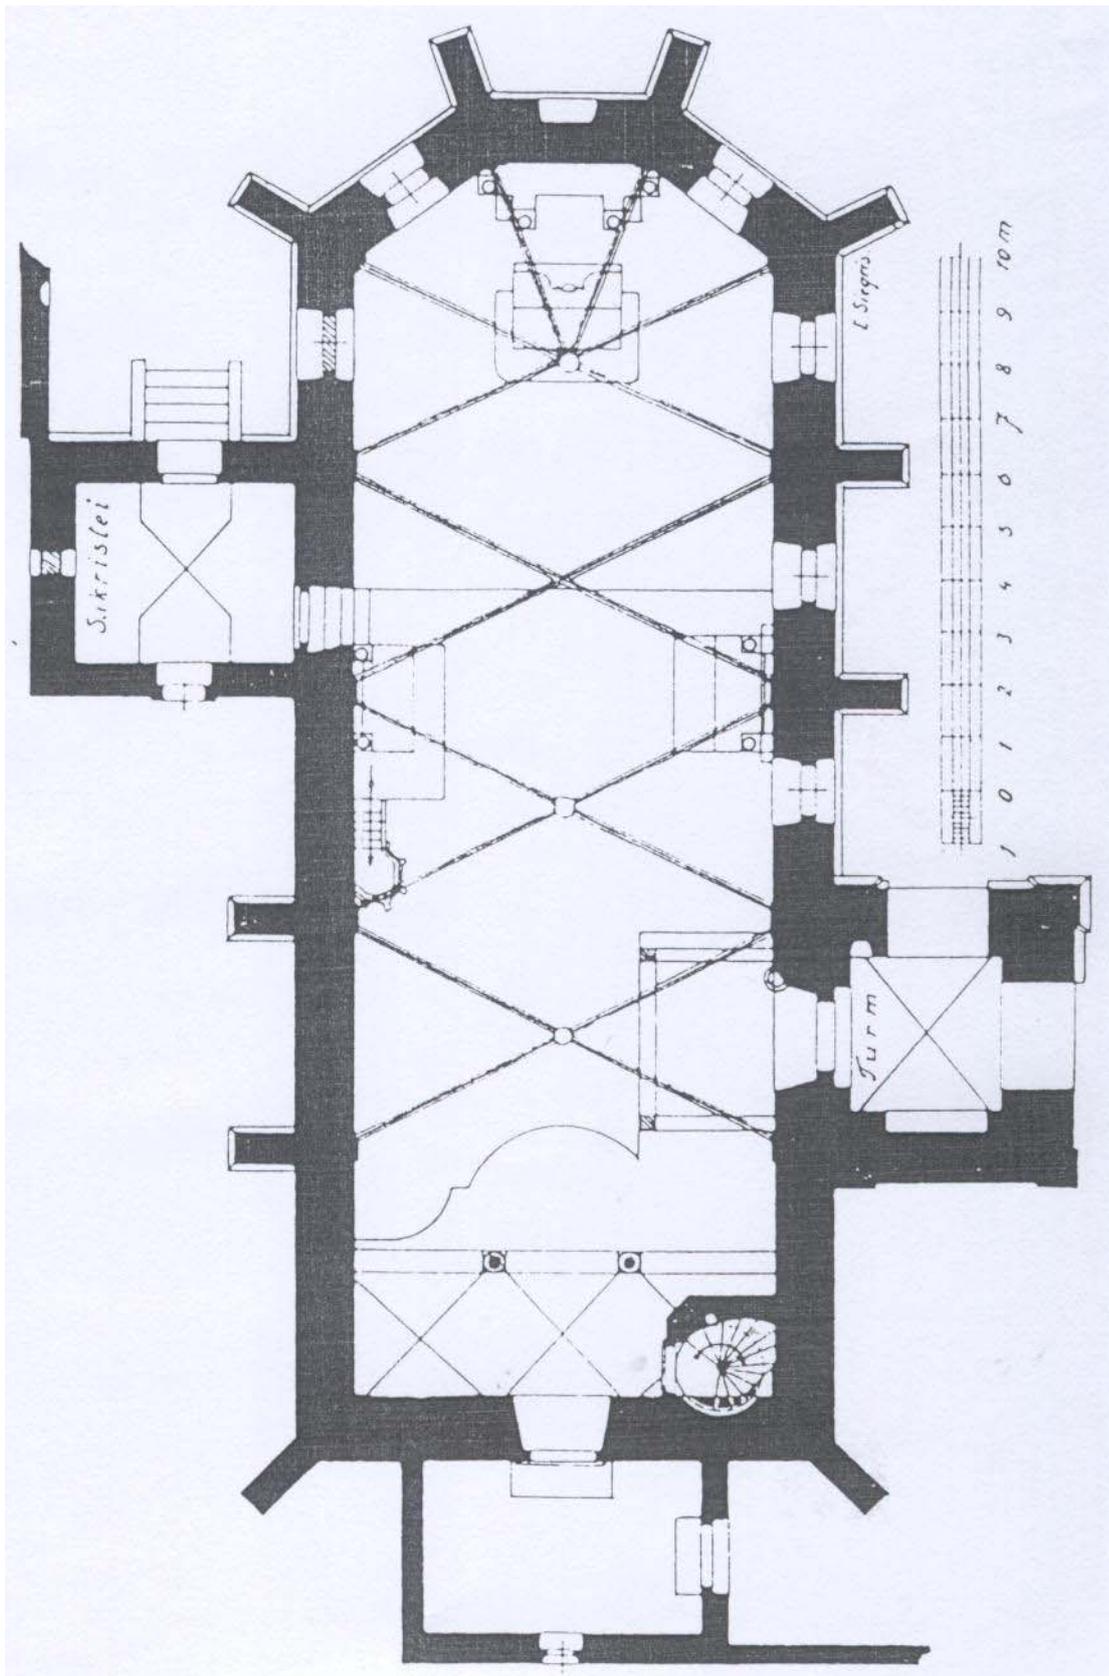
, Grundriss 9, Steinbrunn, Pfarrkirche³³¹
